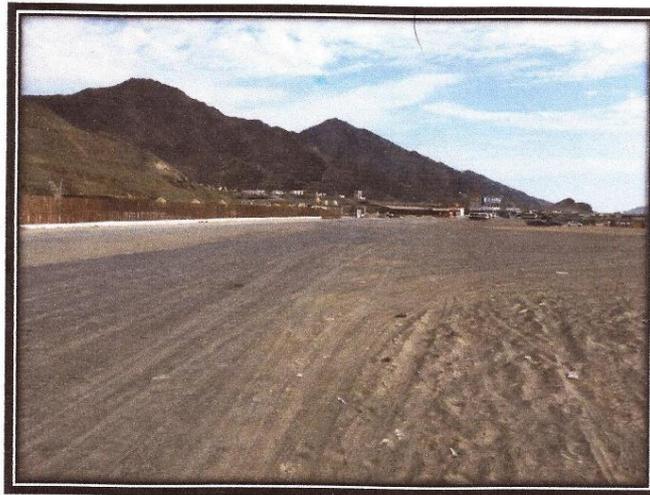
Se visualiza el desgaste y mal estado de la estructura de la carretera pavimentada.
